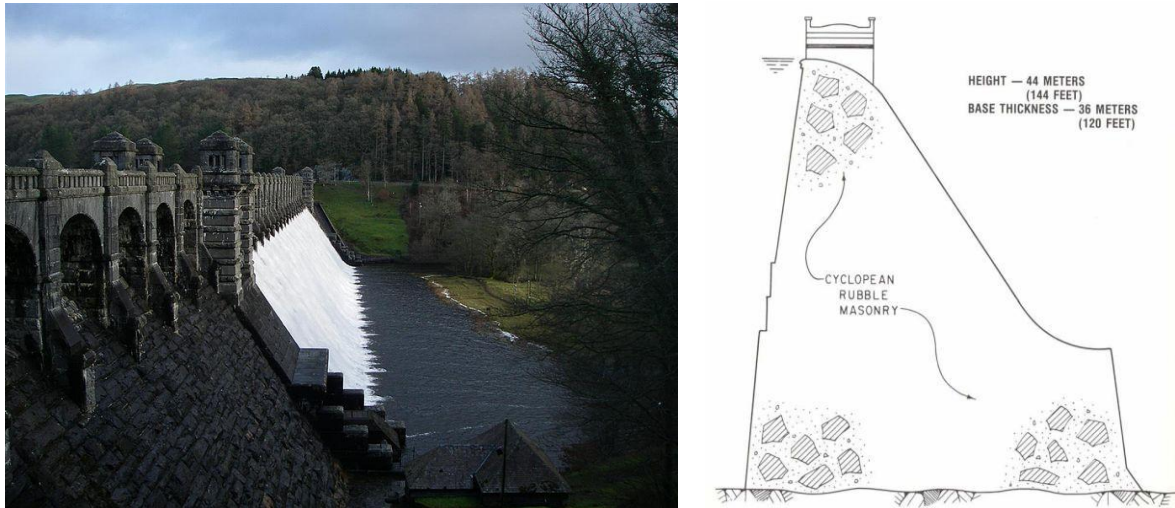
Vista geral e secção da Barragem Vyrnwy (Inglaterra, 1882) [64]
